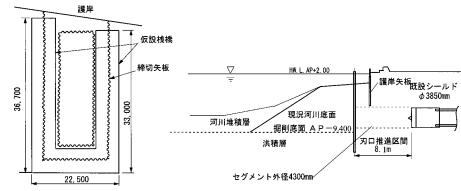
に示すように、河川の護岸に向 図-1 セグメント推進施工例-1 概要図
